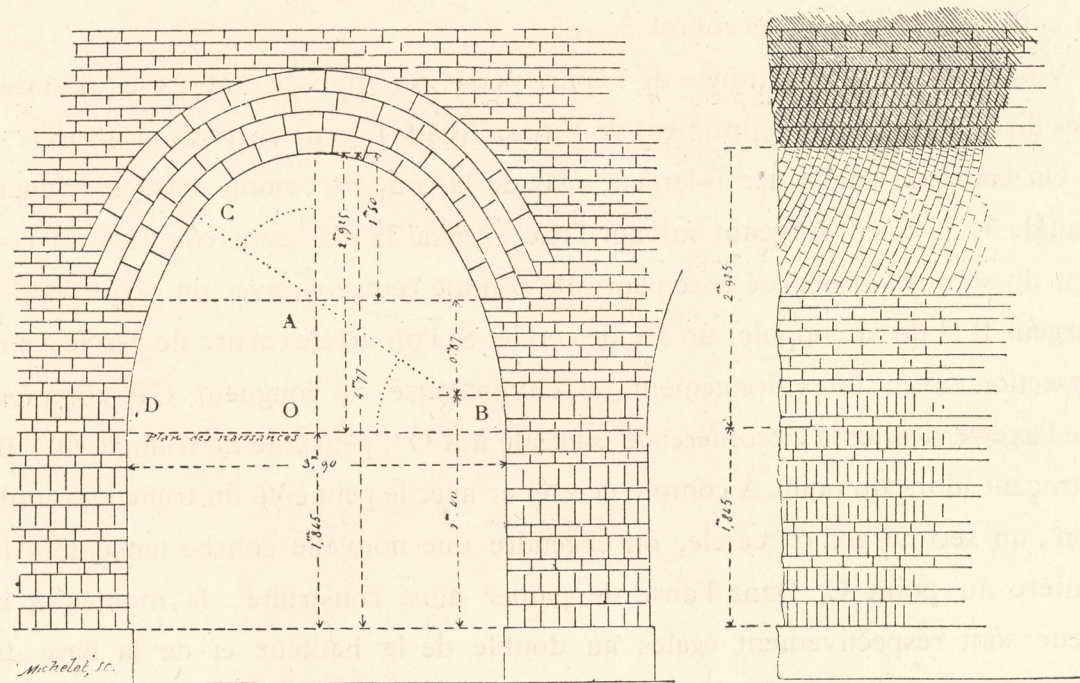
Coupe transversale et coupe longitudinale du berceau du Ramesseum.
